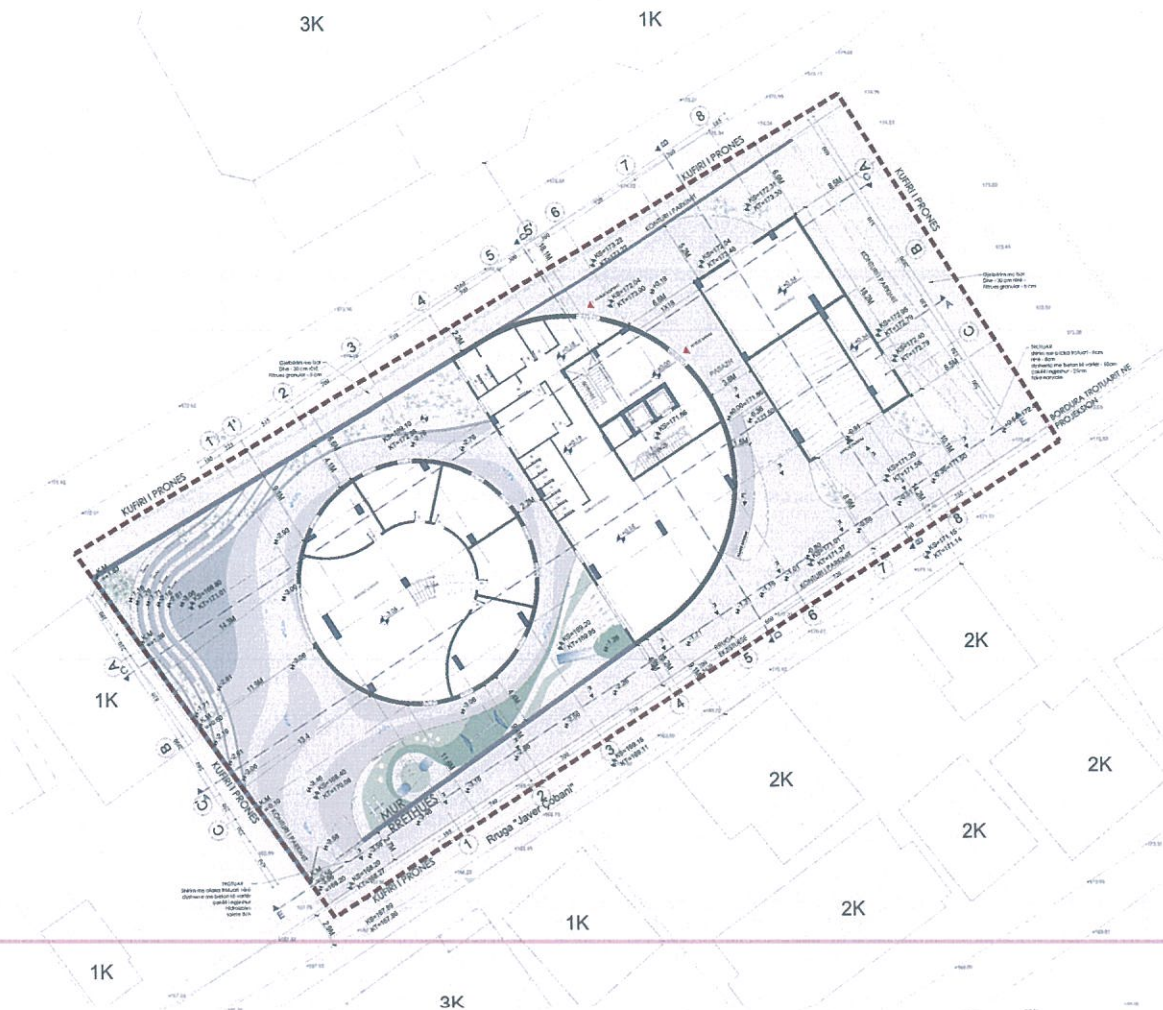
Planimetria e katit përdhe në kuotën ±0.00
